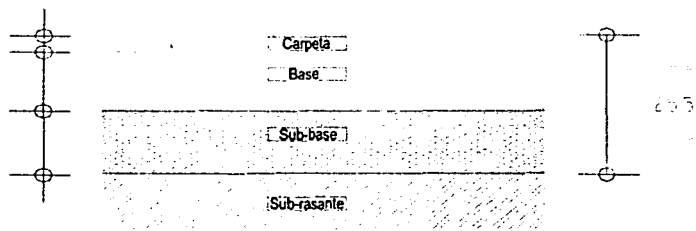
Estimación de espesores para pavimento flexible, zona no crítica, calle de rodaje de salida
